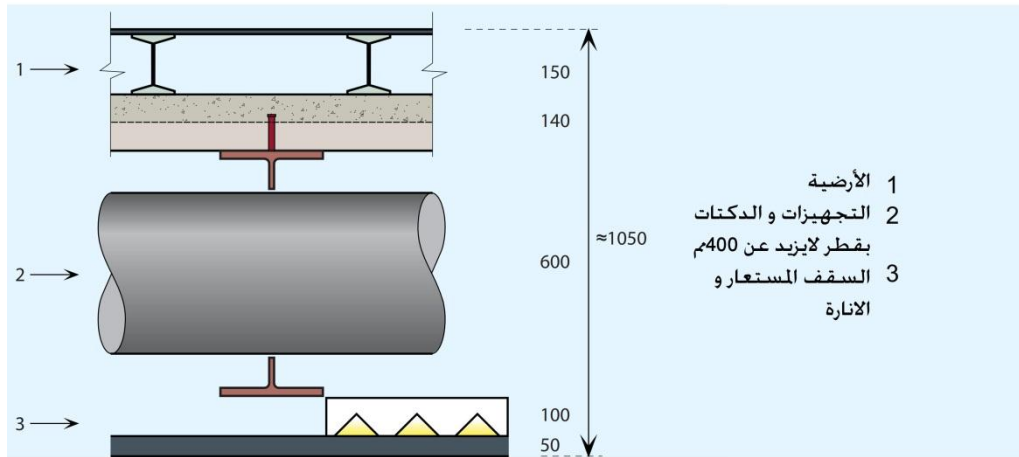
السماعات الدنيا للبلاطات البيتونية. المصدر [16]
